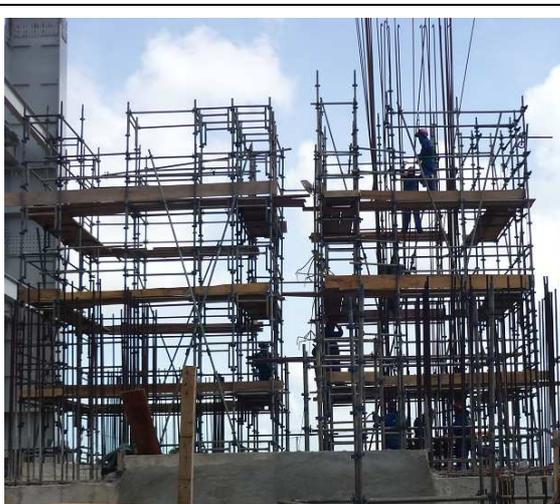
Montagem das torres de cimbramento do pilar C2 à esquerda e serviço de armadura no primeiro nível no pilar C4 à direita.
